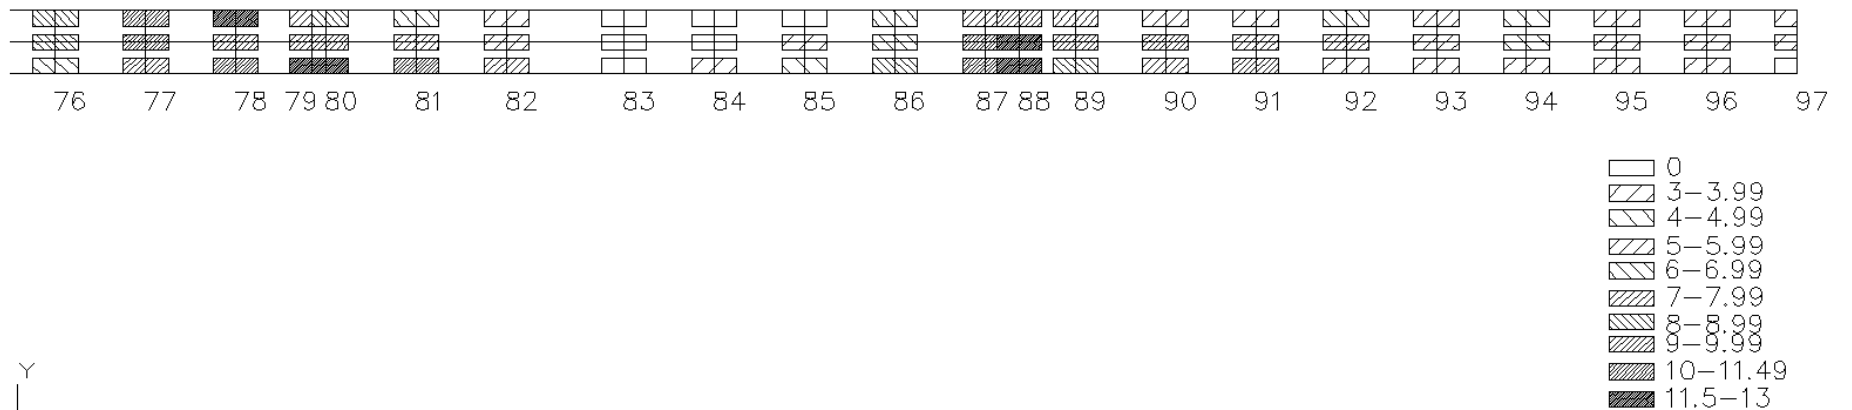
Ausgleichsdicken bei Tangenten und quadratischen Parabeln und Verfahrensplan Typ V, Grundriss, Stationen 76-97
